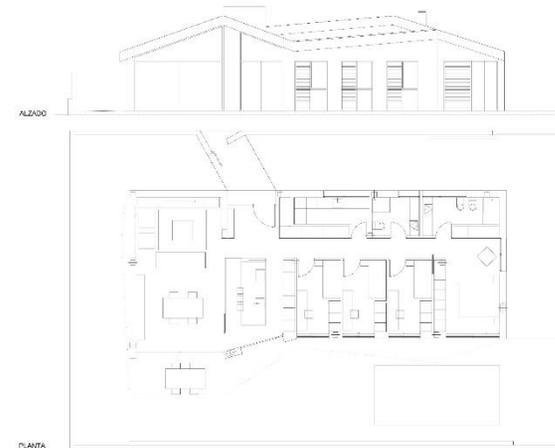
Planta y alzado. Fuente: Documentación Chiralt Arquitectos
